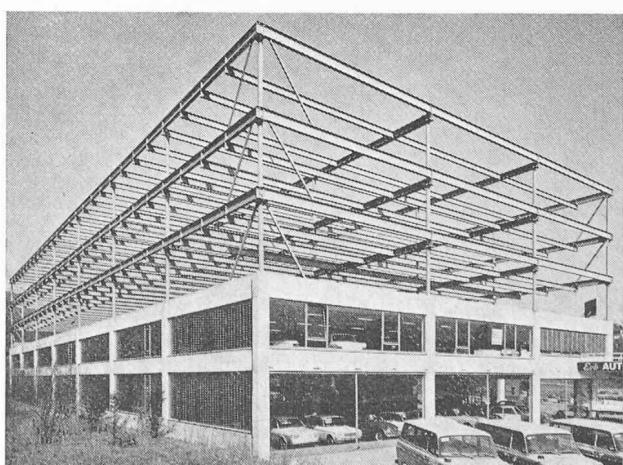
Exemple de construction métallique présentant des assemblages simplifiés au maximum : surélévation de trois étages sur une construction en béton de deux niveaux.
